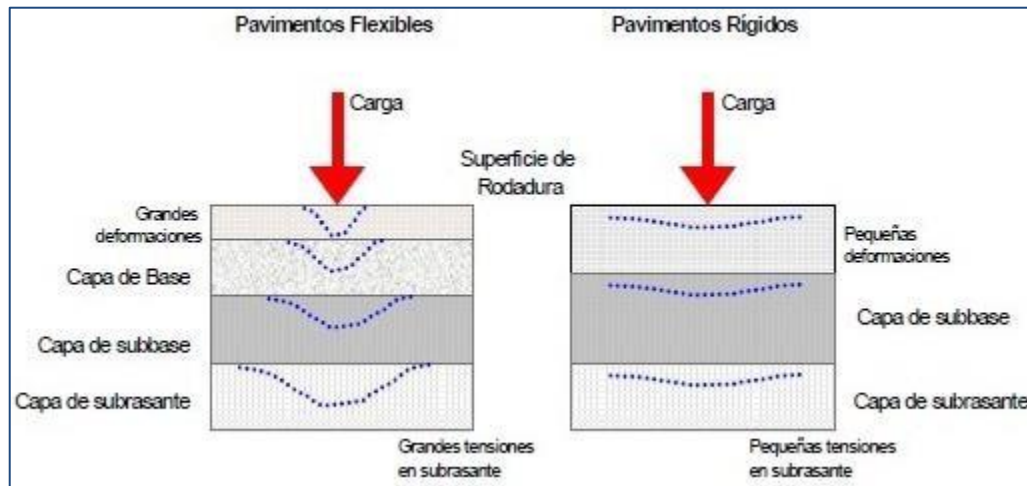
Partes de la estructura según el tipo de pavimento.
